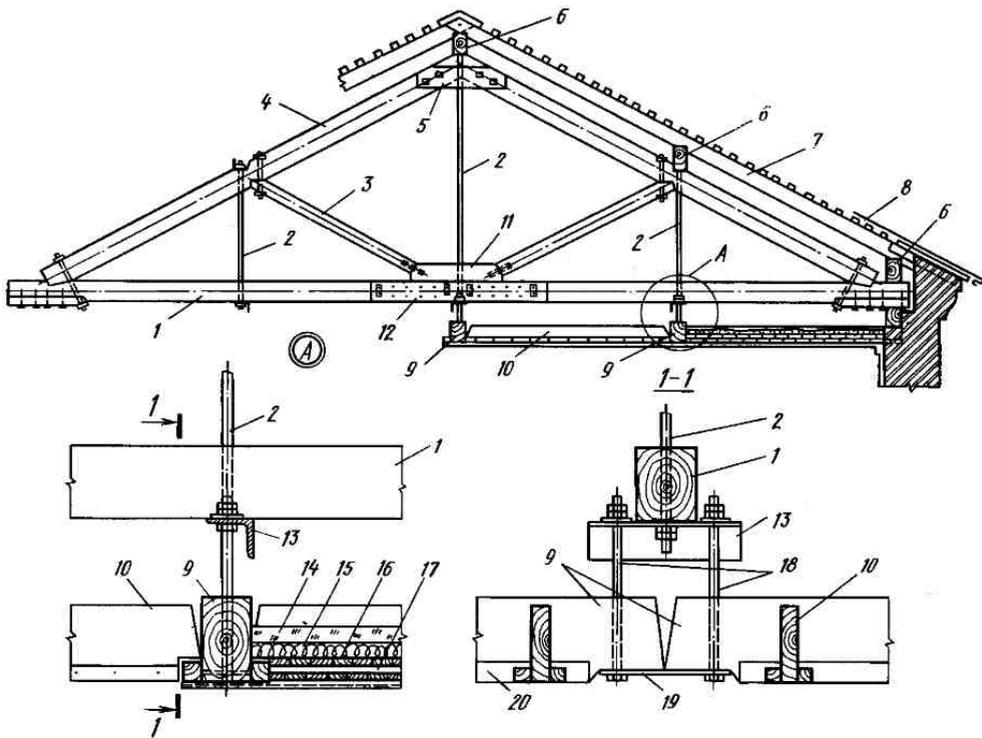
Металлодеревянная ферма с подвесным чердачным перекрытием:
